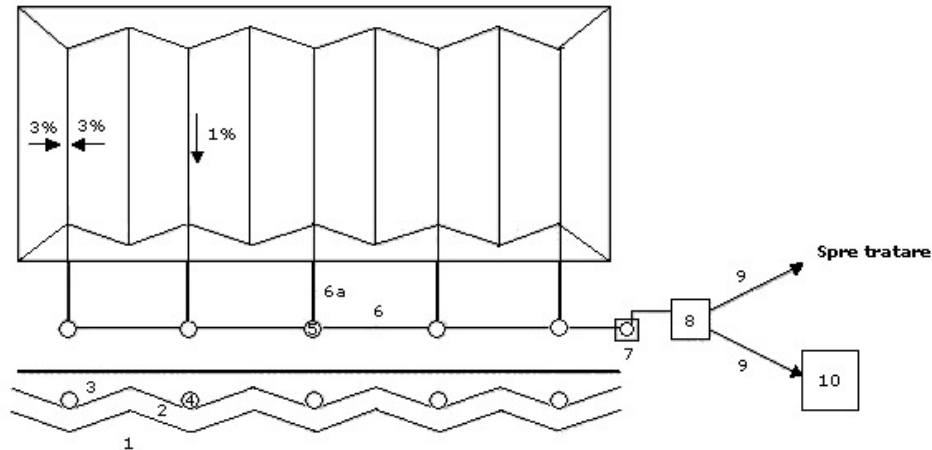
Schema sistemului de colectare a levigatului: 1 - barieră geologică; 2 - impermeabilizare, 3 - strat de drenaj pentru levigat; 4 - conductă de drenaj pentru levigat; 5 - cămin pentru levigat; 6 - conductă de colectare pentru levigat; 6a - zonă în care se amplasează sistemele de control al scurgerilor; 7 - stație de pompare pentru levigat; 8 - rezervor pentru levigat; 9 - conductă de eliminare pentru levigat; 10 - instalație de transvazare pentru levigat.
